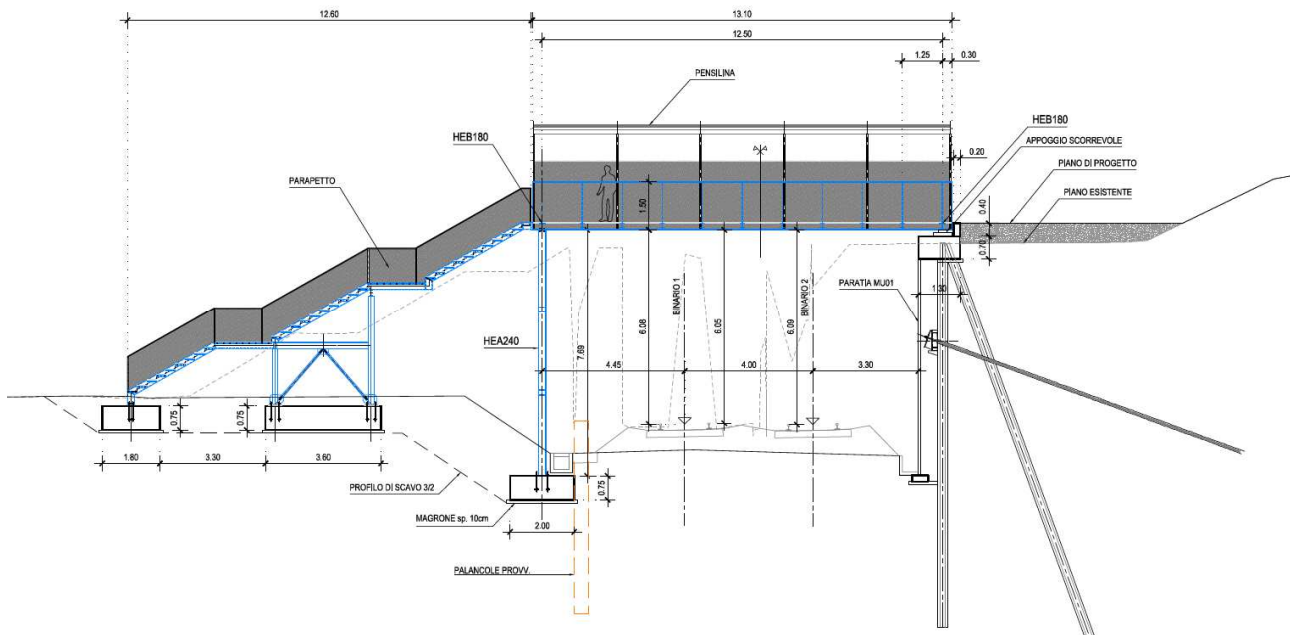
Passerella pedonale – Sezione longitudinale
